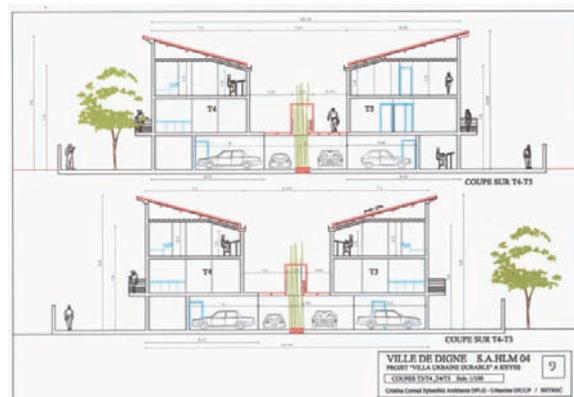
/ Opération de Digne les Bains : la voiture prend place dans un socle sous les logements. Les logements traversant s'ouvrent d'une part sur des balcons, d'autre part sur des terrasses en cœur d'îlots.
